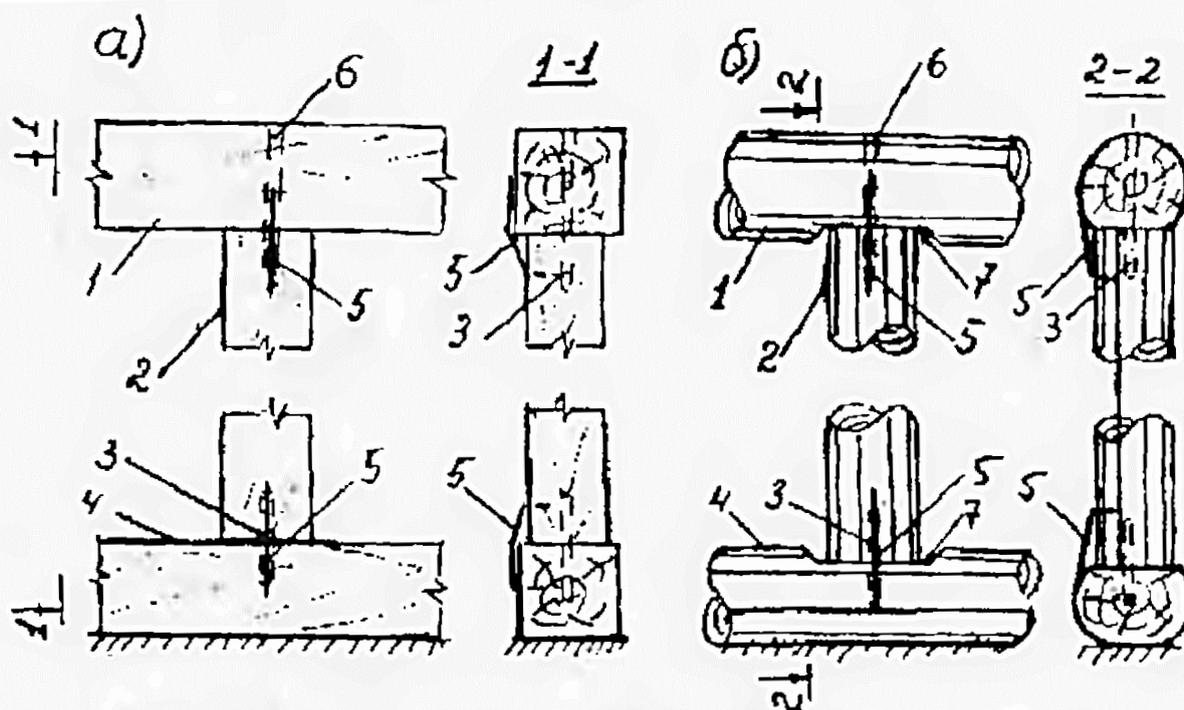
Опиране прогона на стойку и стойки на лежень при стропилах:
